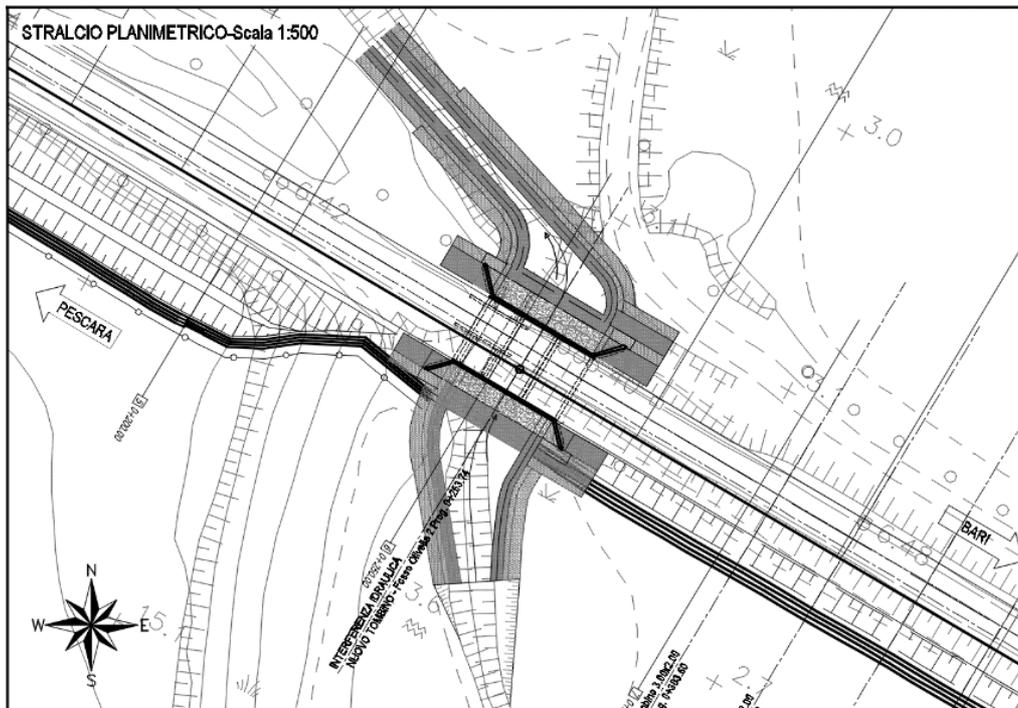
Stralcio Planimetrico e Sezione longitudinale
